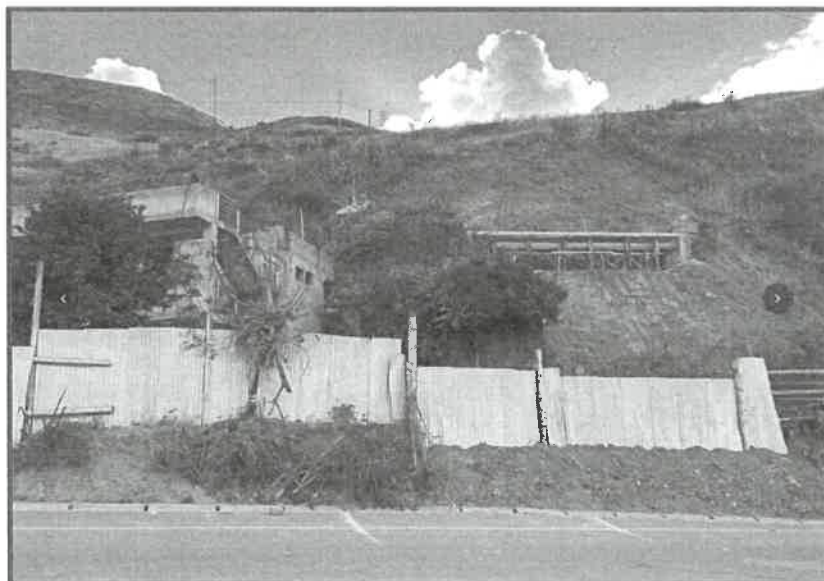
Punto Crítico PC-05. Vista del sector correspondiente al Punto Crítico PC-05, donde se ejecutaron trabajos de reparación tras el colapso del canal de conducción. Se observa la estabilización parcial del talud y las obras provisionales implementadas, identificándose este sector como el más adecuado para la instalación de la propuesta del sistema provisional
